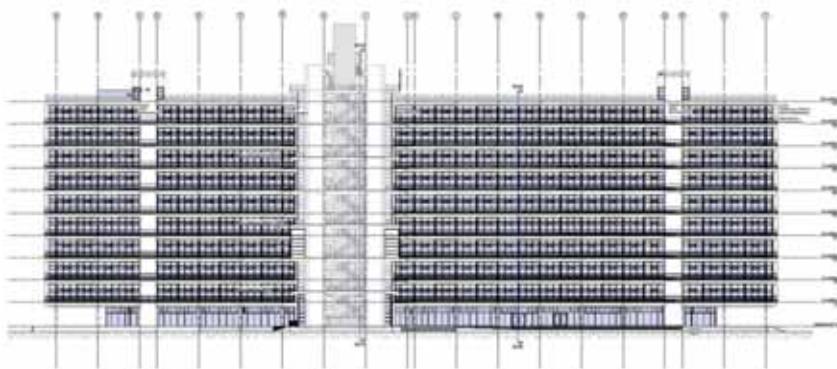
Prospetto di progetto del caso studio olandese Hogekamp a Enschede (Olanda)
